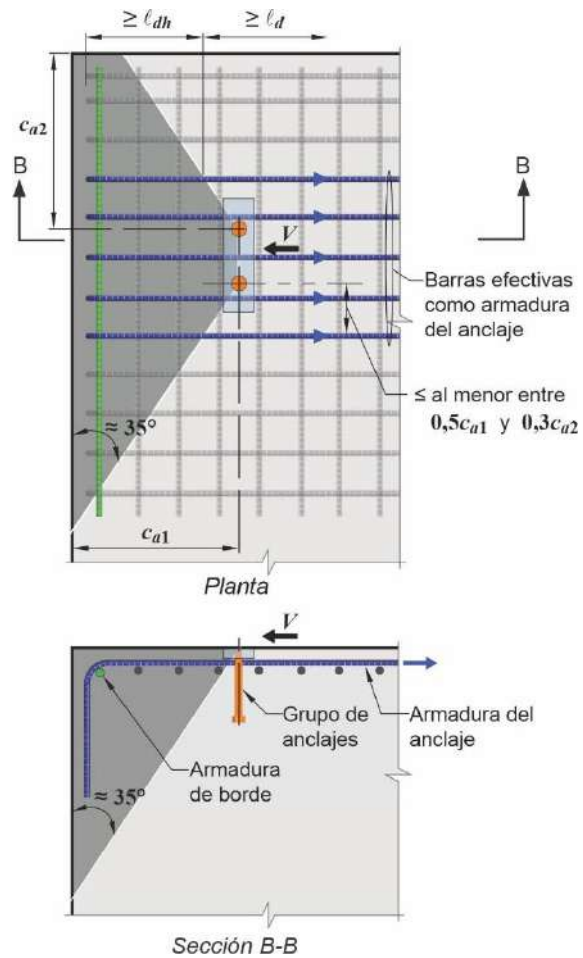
(ii). Armadura de borde y armadura del anclaje para corte
